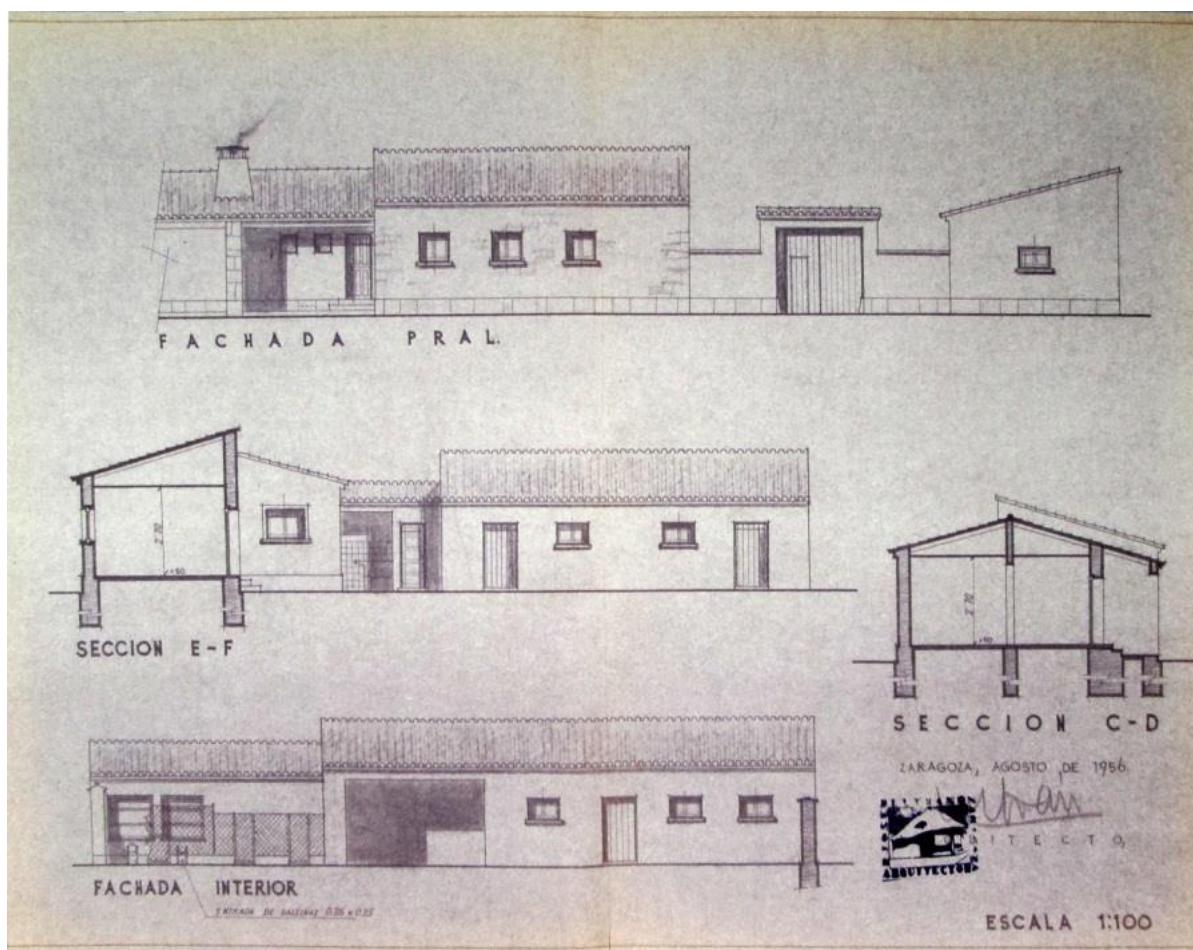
Alzados de vivienda de Cantalobos. Fuente: ACMA.
